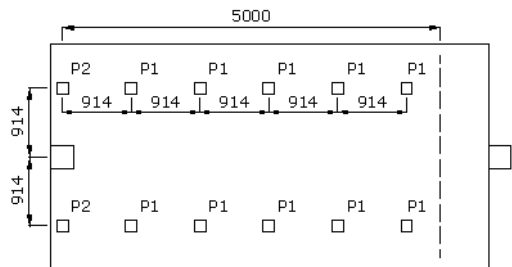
Detalhe da aplicação de cargas horizontais no pilar - REGAN (1993)
